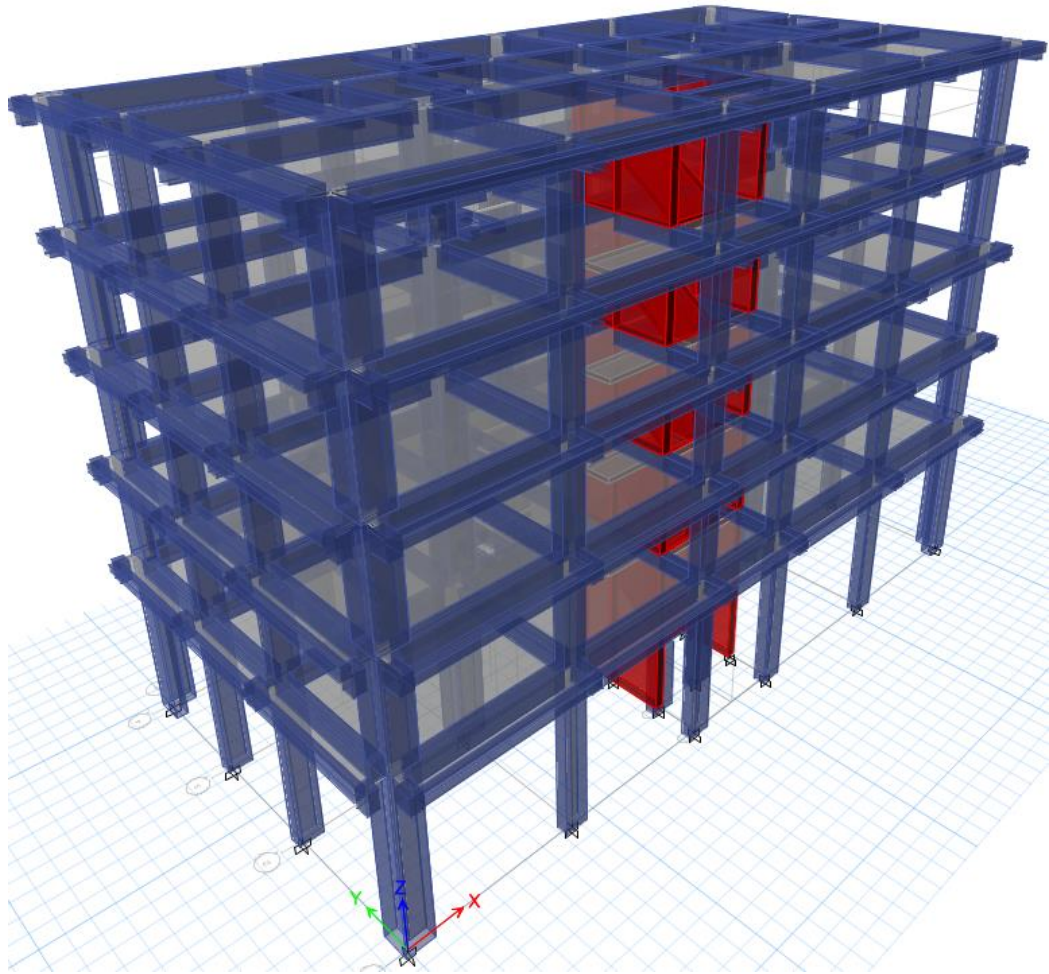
Modelado de la estructura en Etabs, vista 3D. Tomada de Etabs 21.
